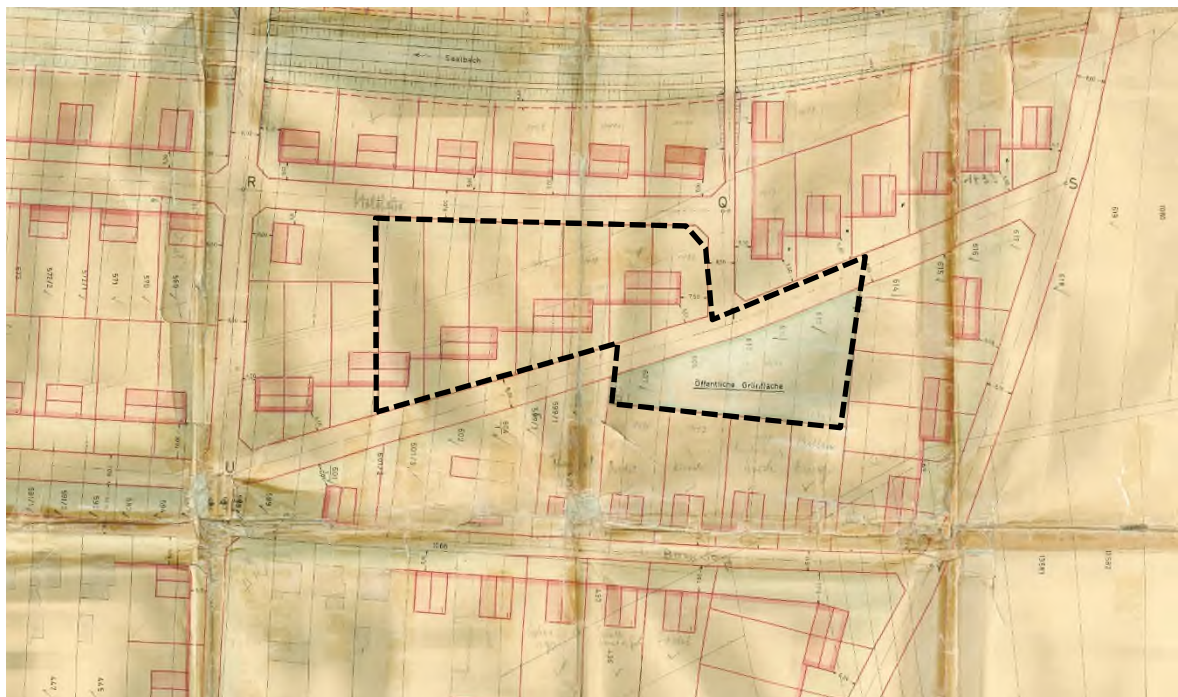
Bebauungsplan „Kälberweide“, Ausschnitt Bismarckstraße/Moltkestraße mit Änderungsbereich
